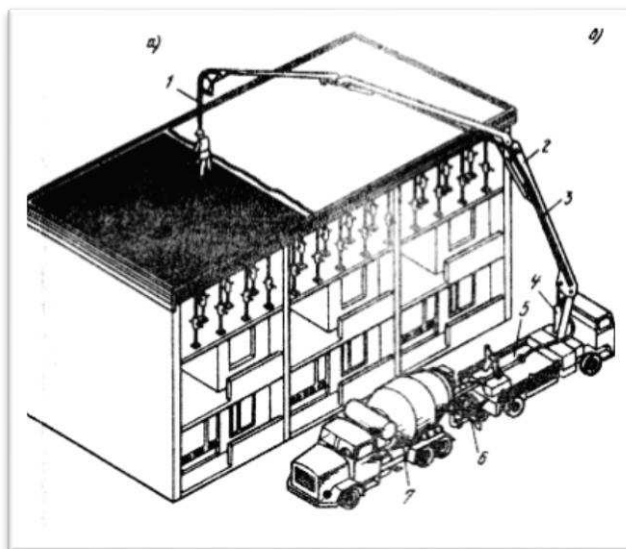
Подача бетонной смеси автобетононасосом
